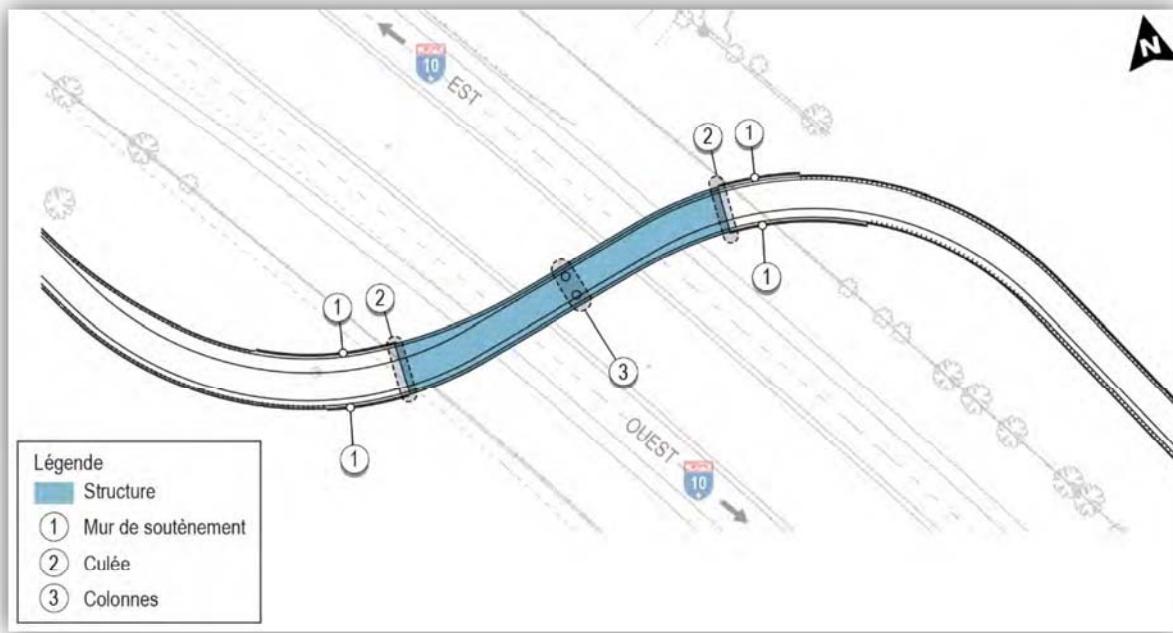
Vue en plan de la nouvelle bretelle autoroutière
